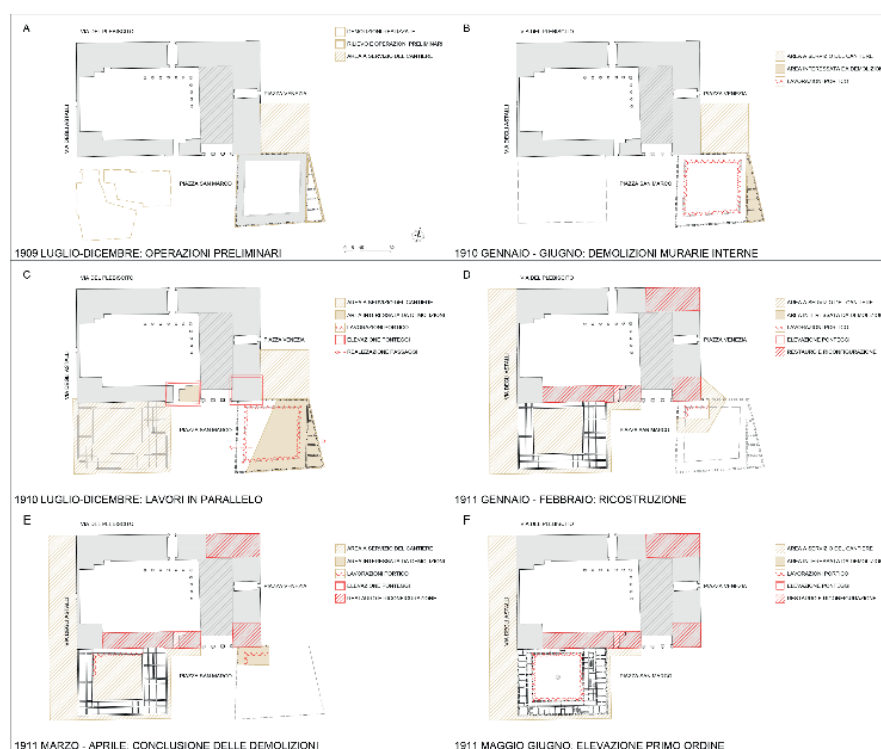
Schema cronologico delle fasi del cantiere 1909-1911. Elaborazione dell'autrice.
